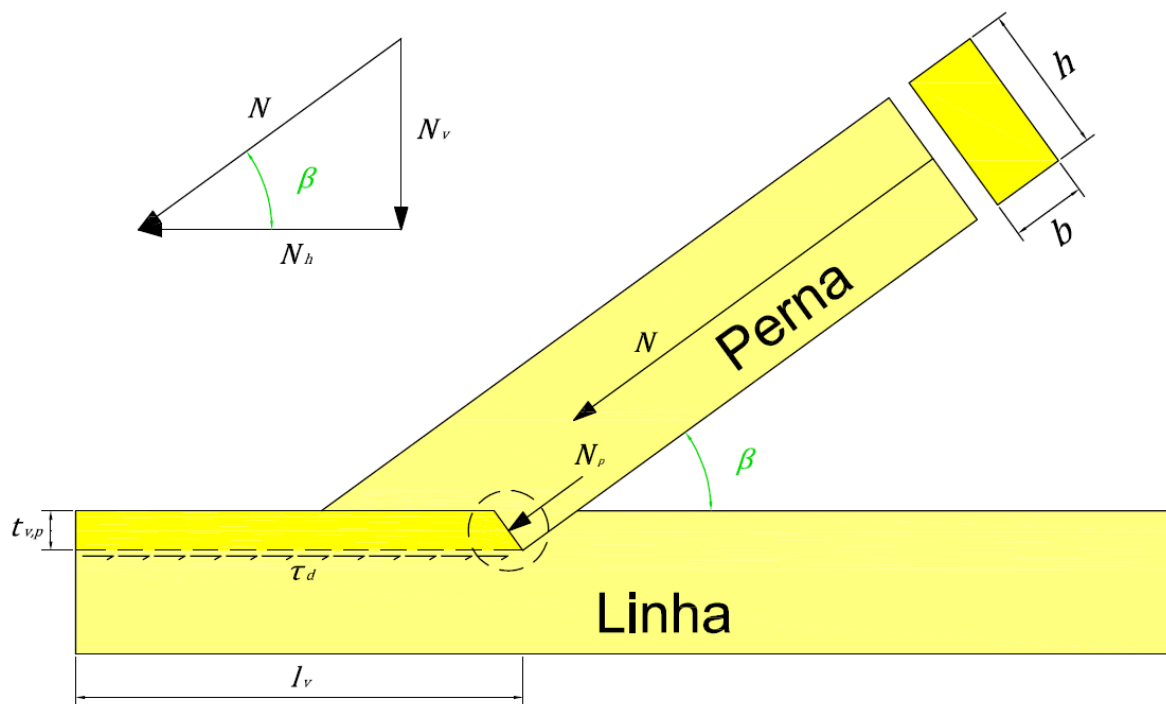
Ligação entalhada perna-linha com dente simples aplicado na parte posterior.
